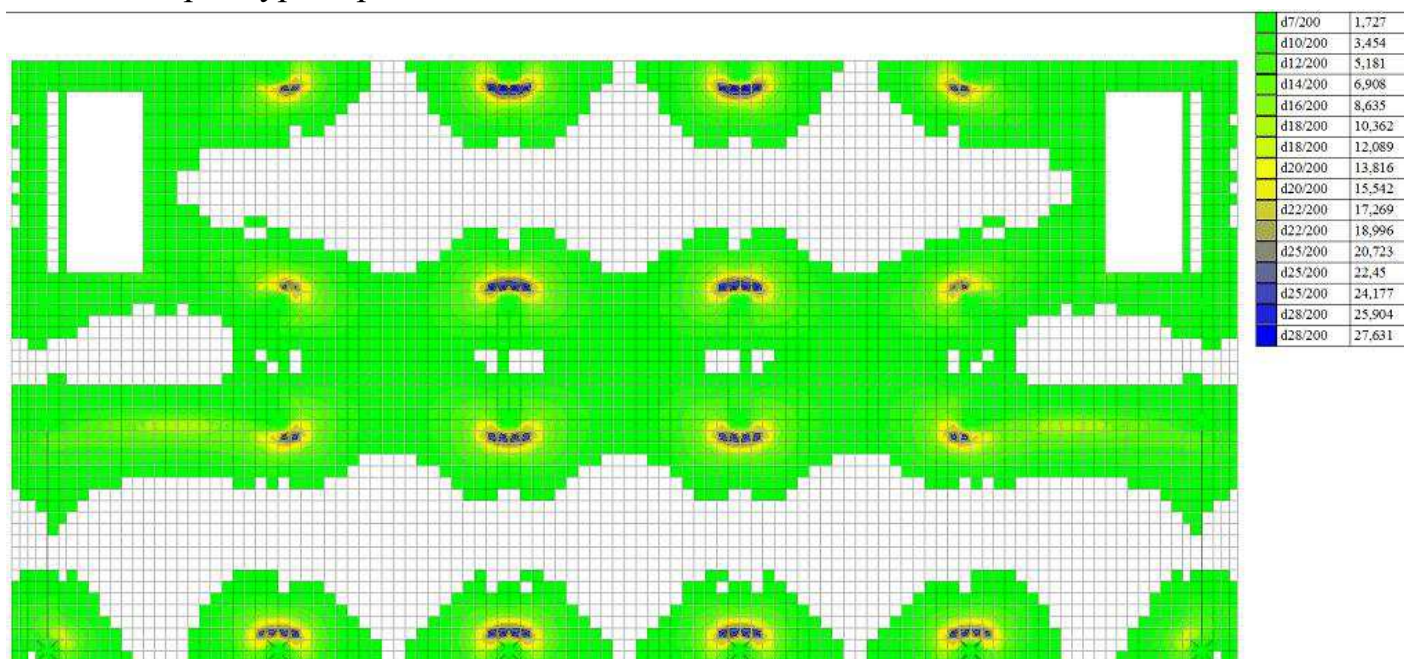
Схема верхнего армирования плиты по оси y
